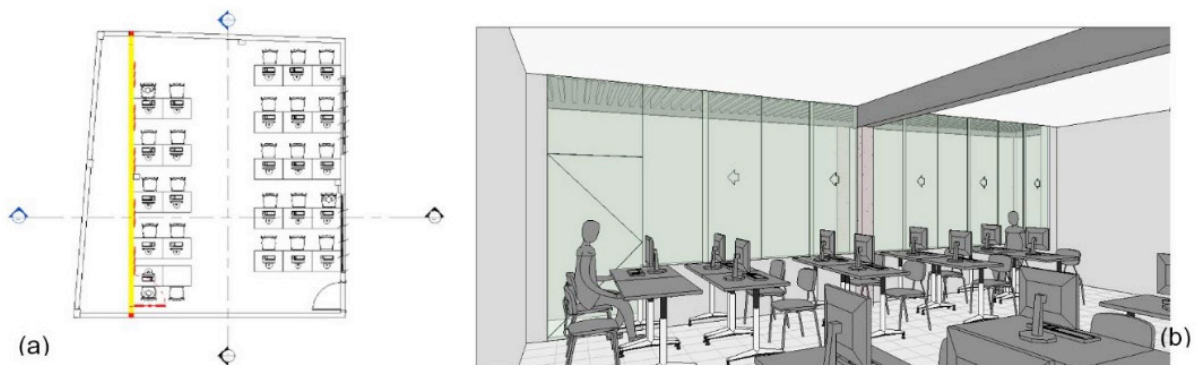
(a) Planta baixa de reforma (Vermelho: a construir; Amarelo: a demolir; Branco: a preservar). (b) Detalhe em 3D do projeto final.
